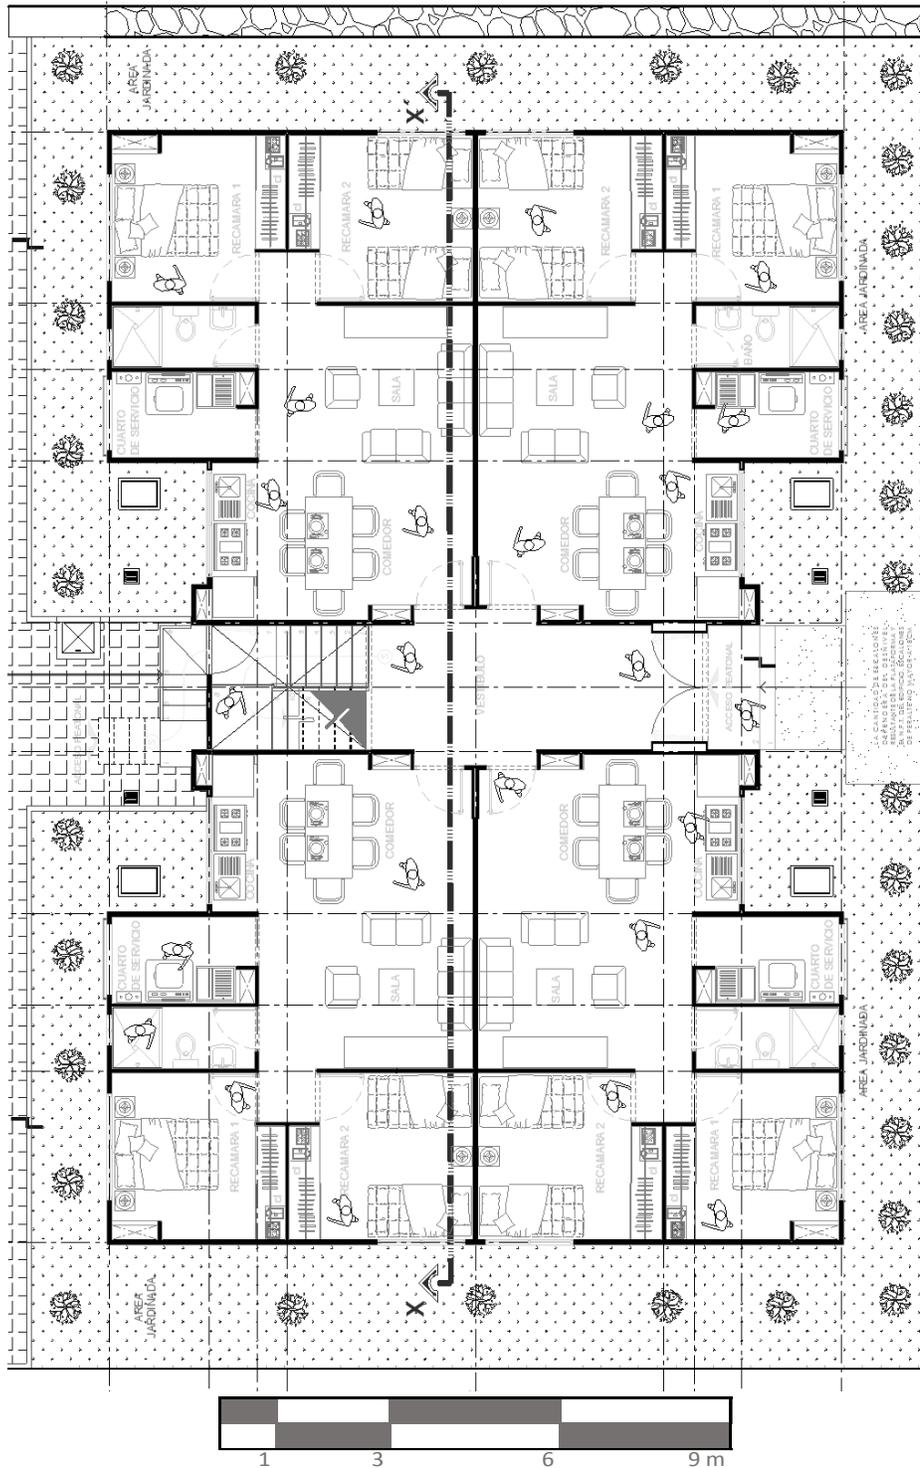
Planta Arquitectónica del Prototipo Departamento 2 Recamaras
